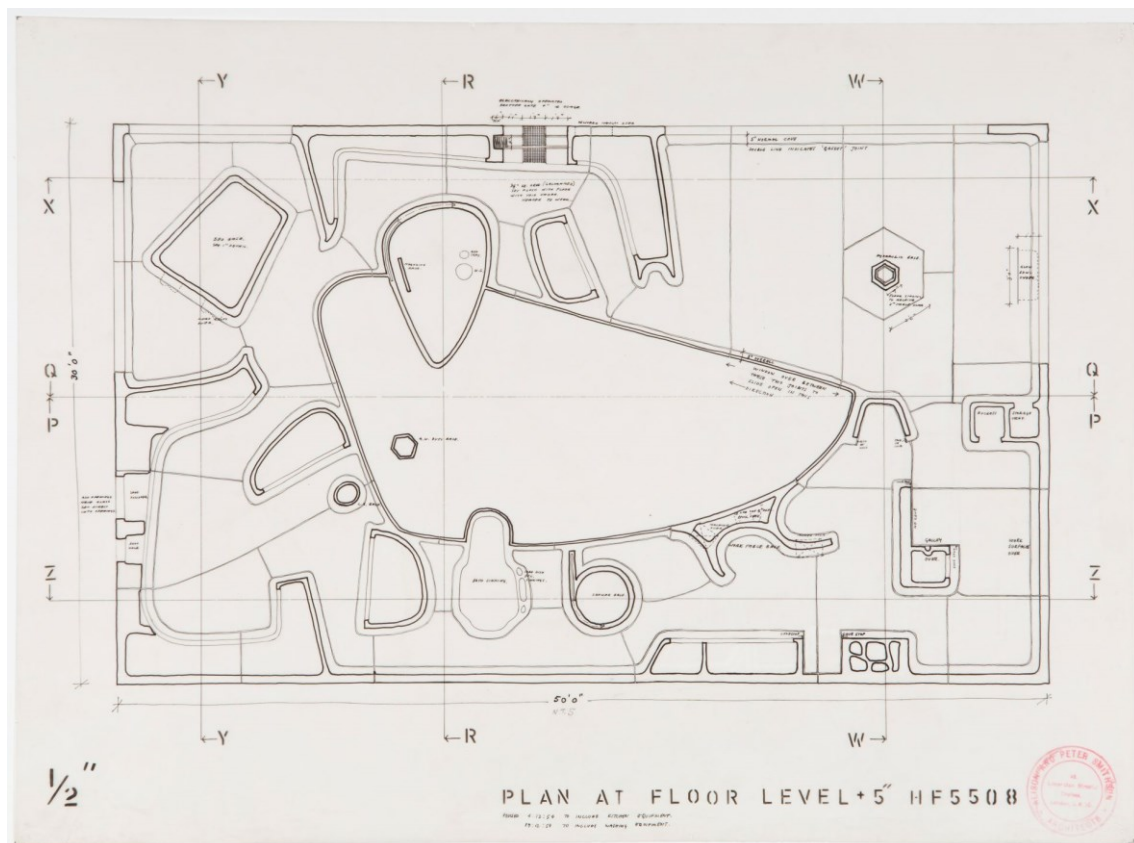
Casa del Futuro*, distribución espacial de la planta (1955-1956).
